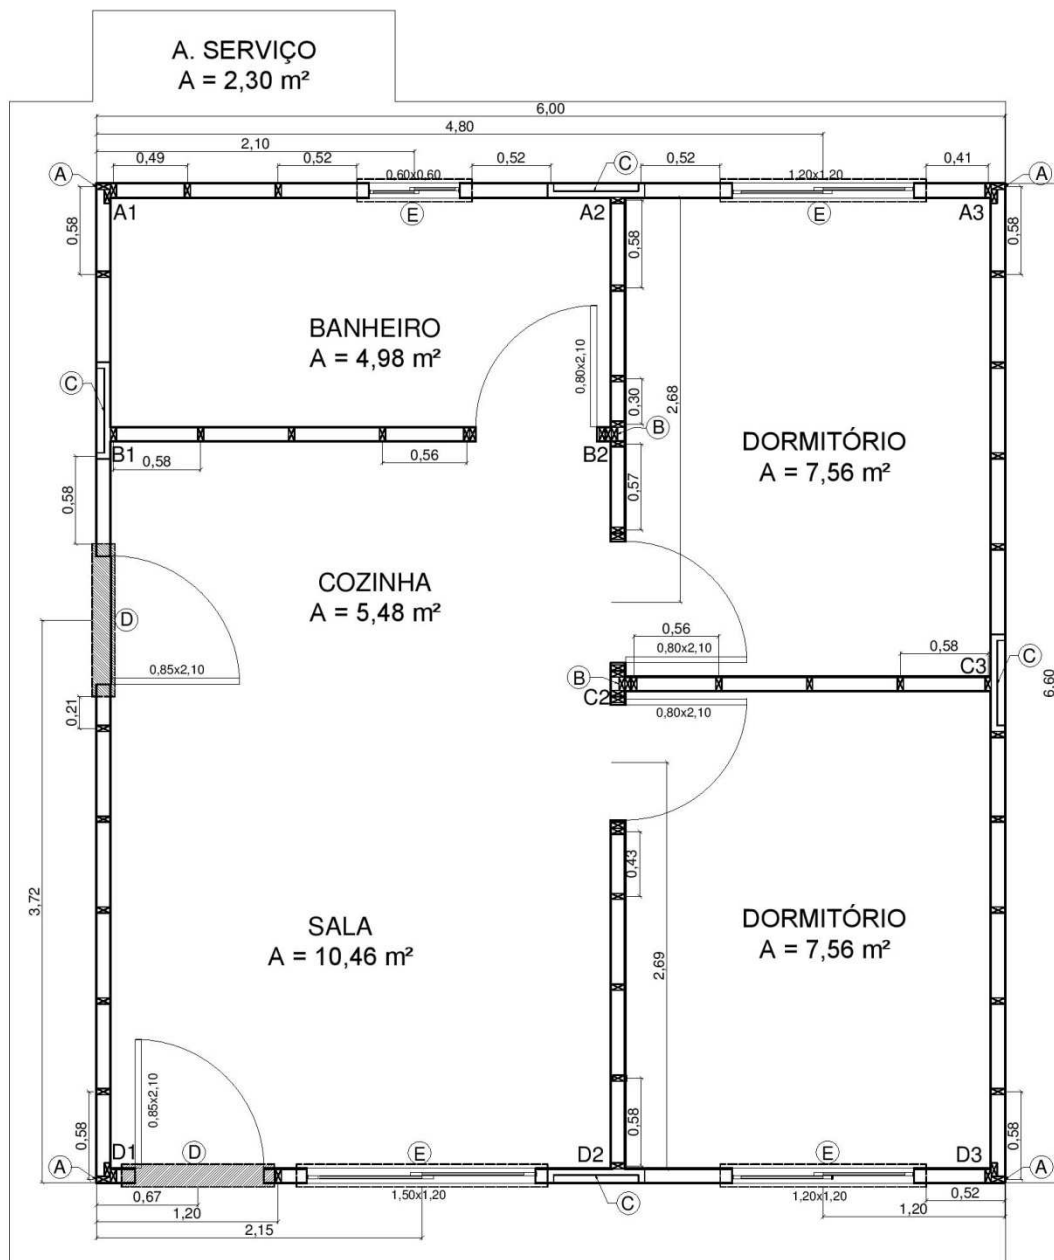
Projeto de Wood Framing: Plano de Corte das Soleiras.
